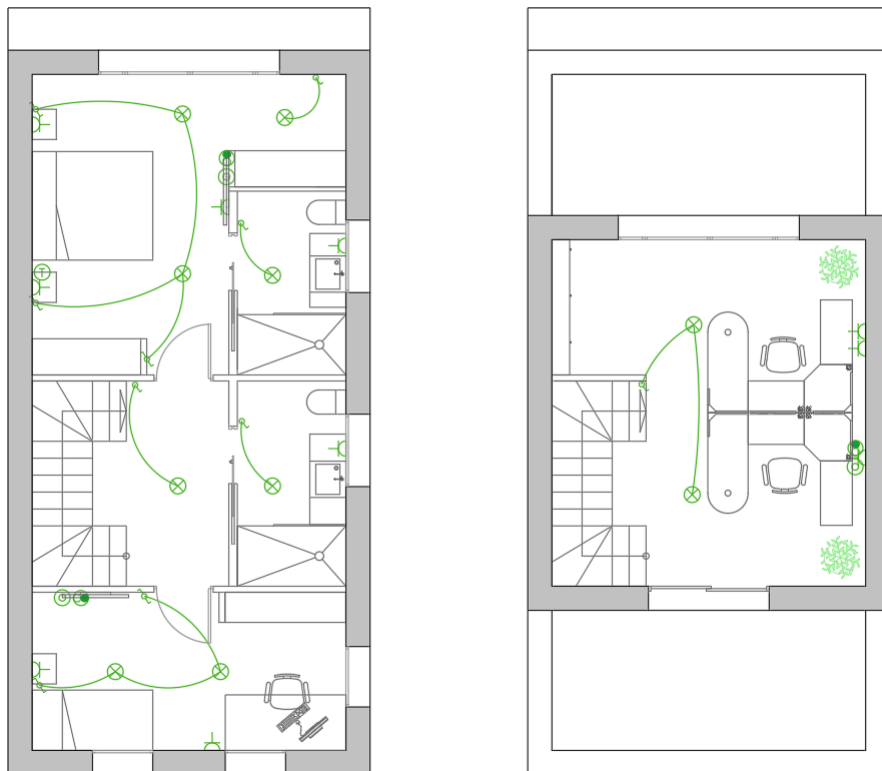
Esquema instalación eléctrica planta primera y planta ático. 2019. Fuente propia.
